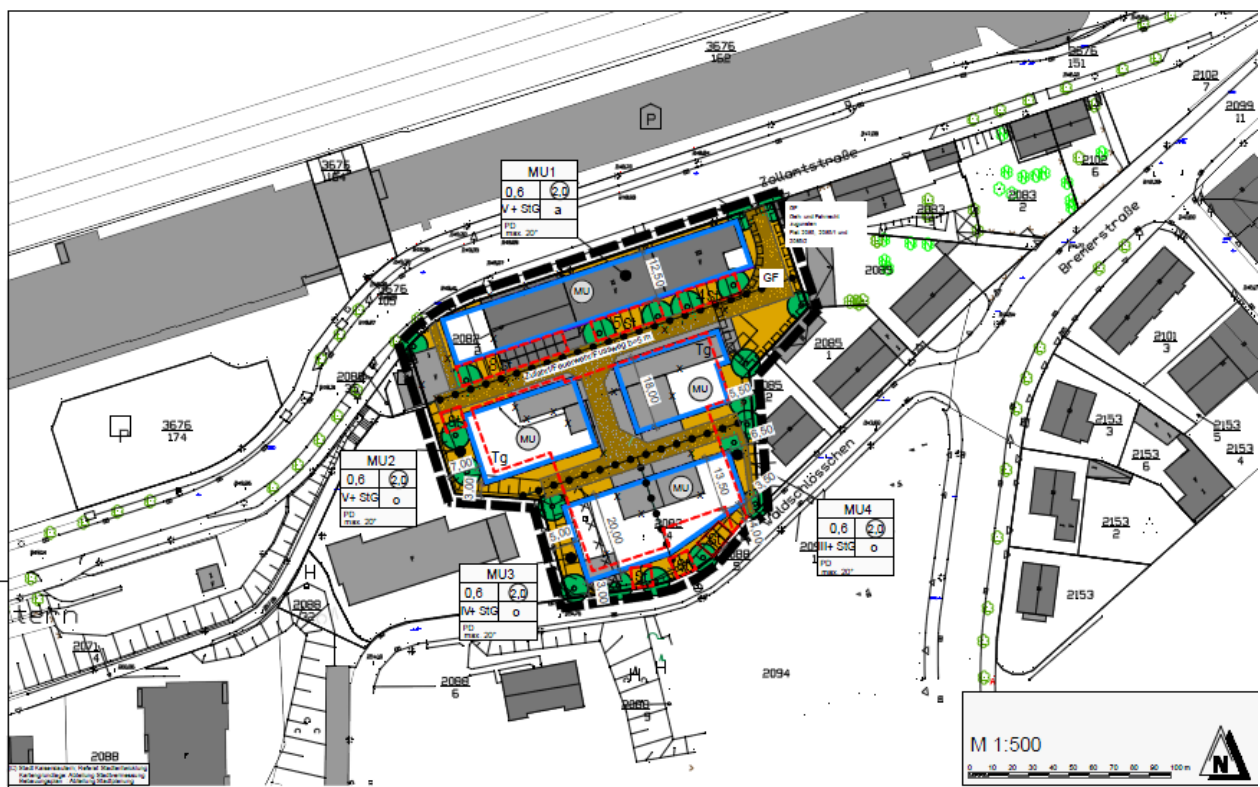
Ausschnitt Entwurf Bebauungsplan; Darstellung: Stadt Kaiserslautern
